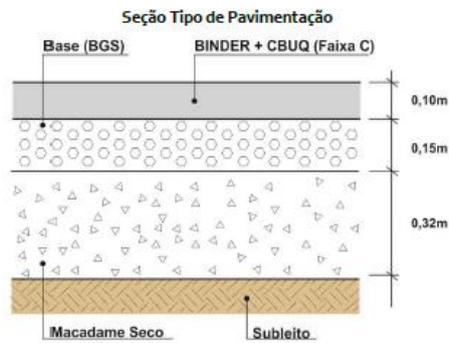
Corte esquemático da estrutura típica de pavimento flexível
